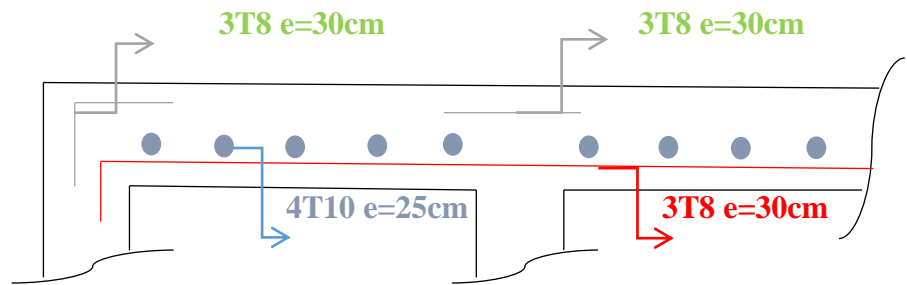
Schéma de ferrailage dalle pleine sous-sol
